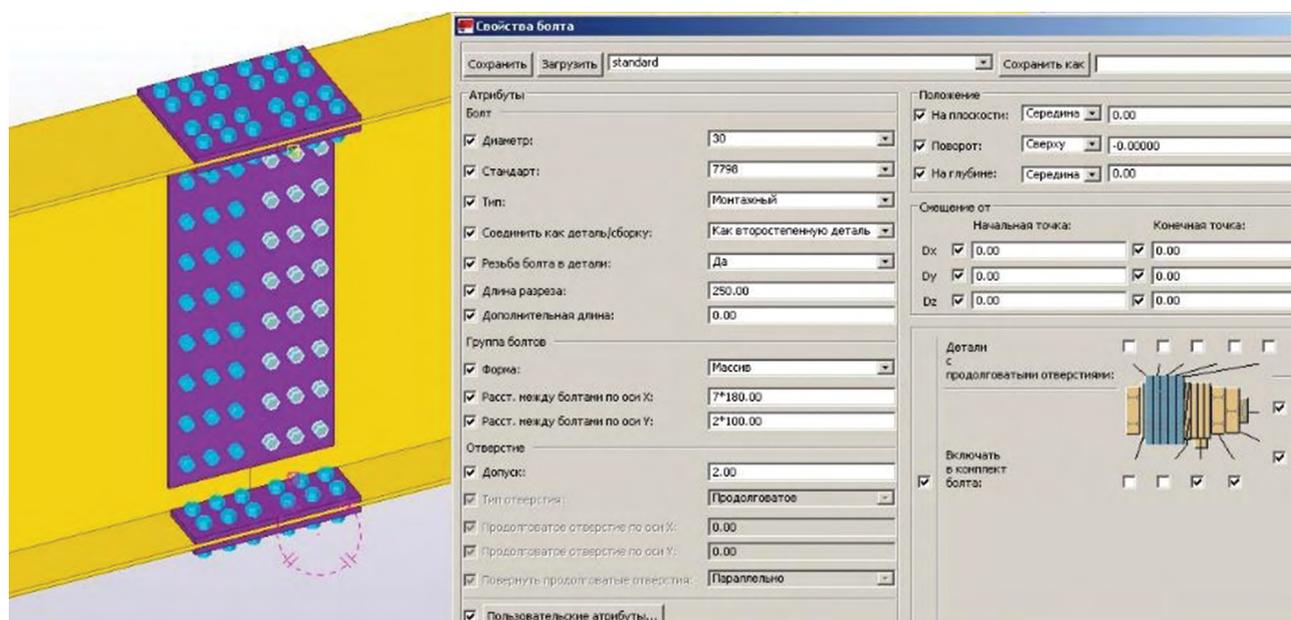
Создание соединения элементов главной балки ГБ1 на болтах
